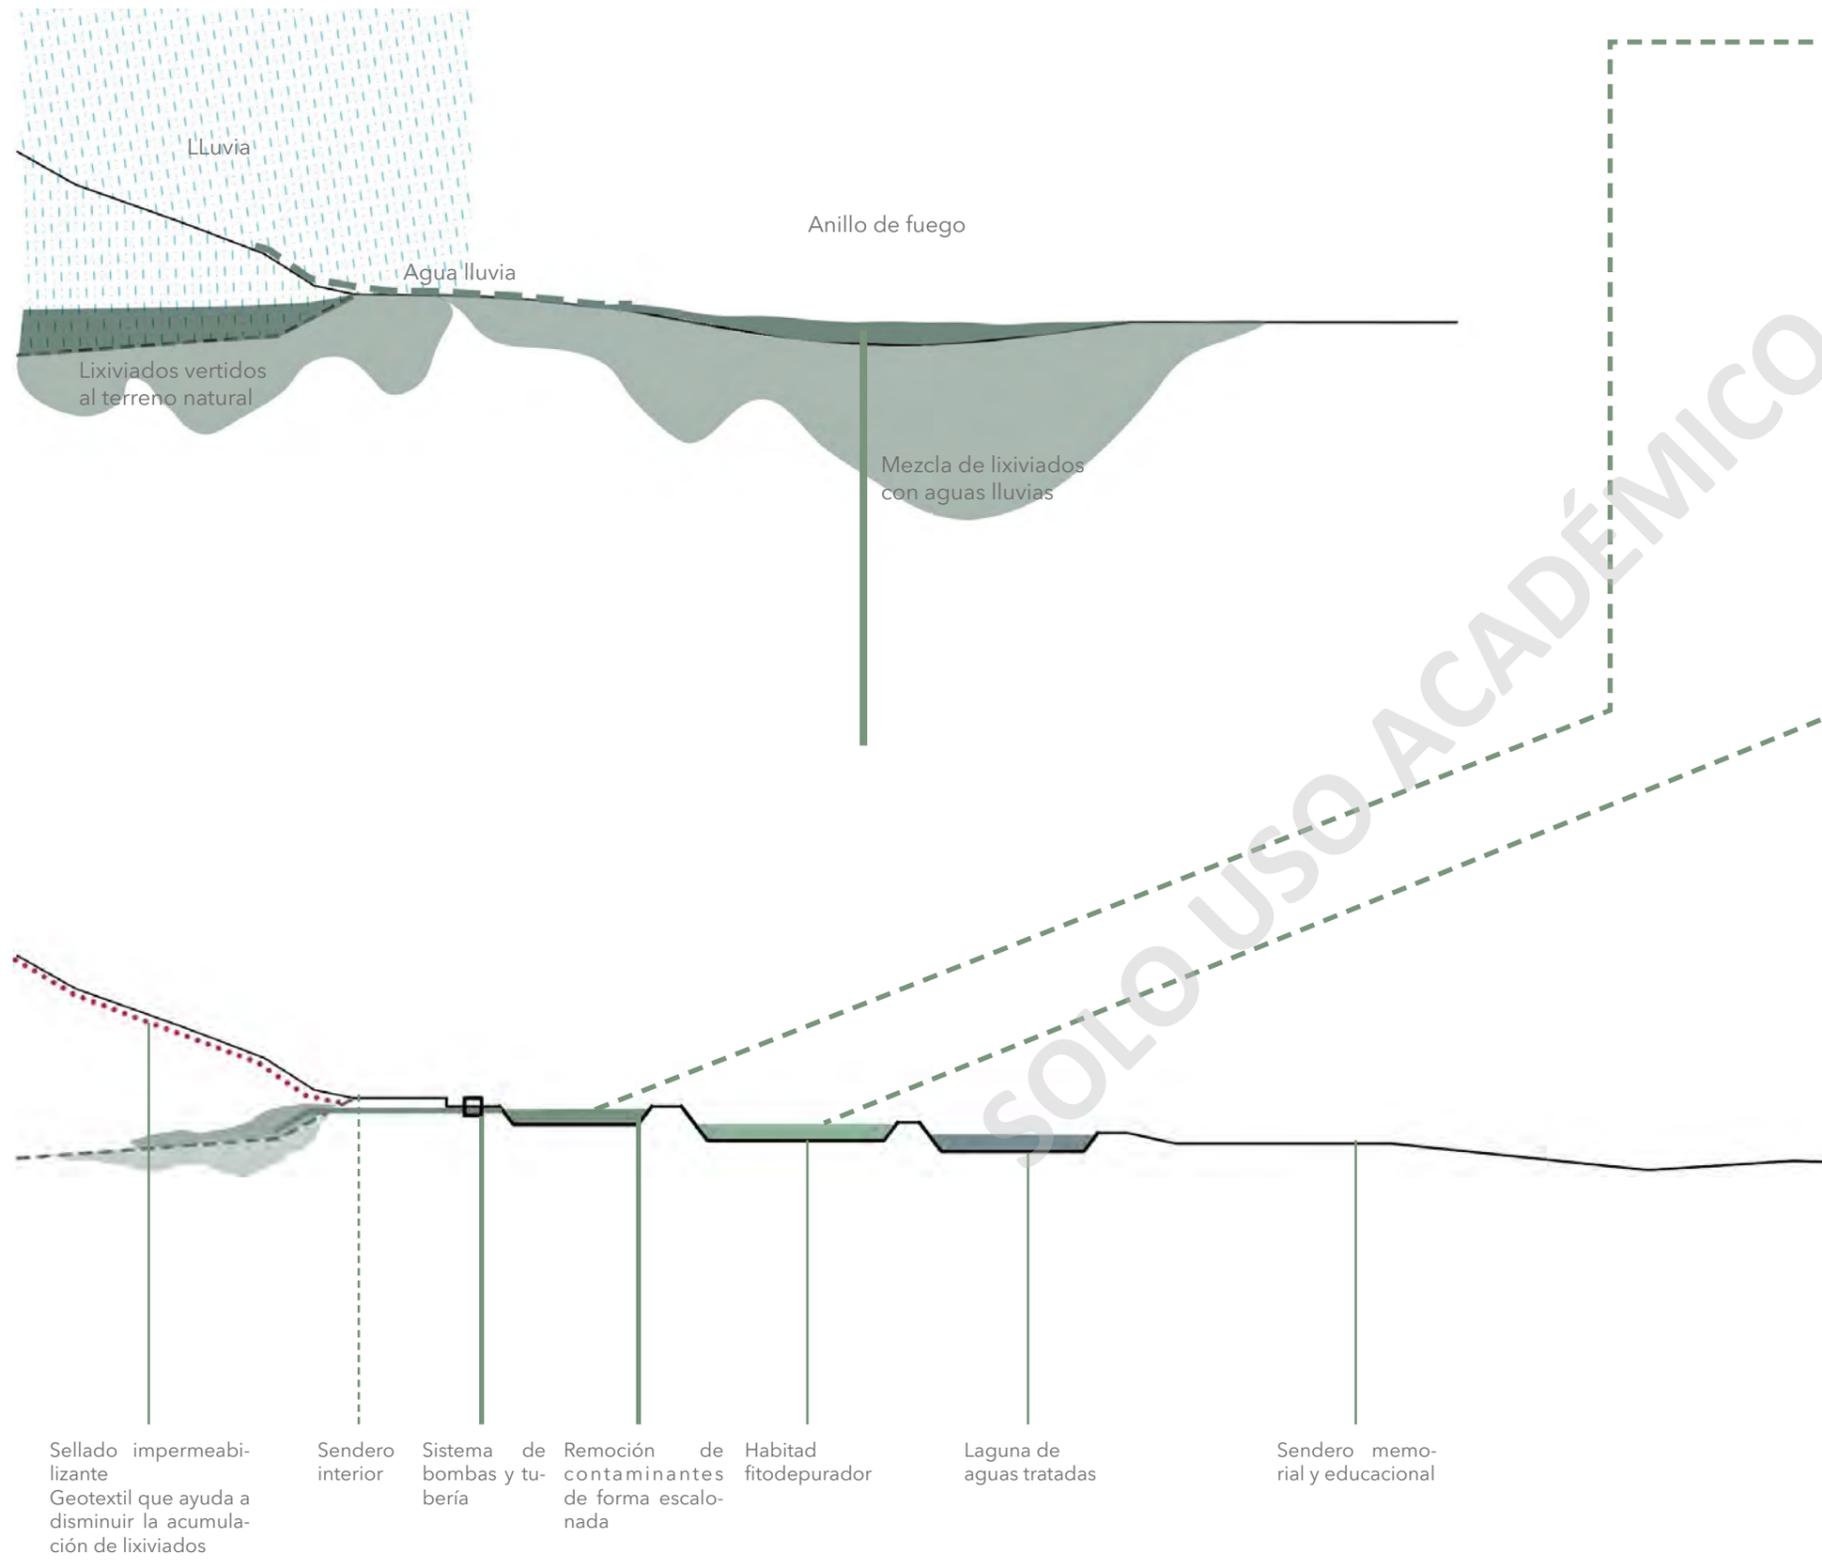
Corte esquemático de tratamiento de lixiviados actual vs la propuesta fitodepuradora. Planimetría de elaboración propia.
